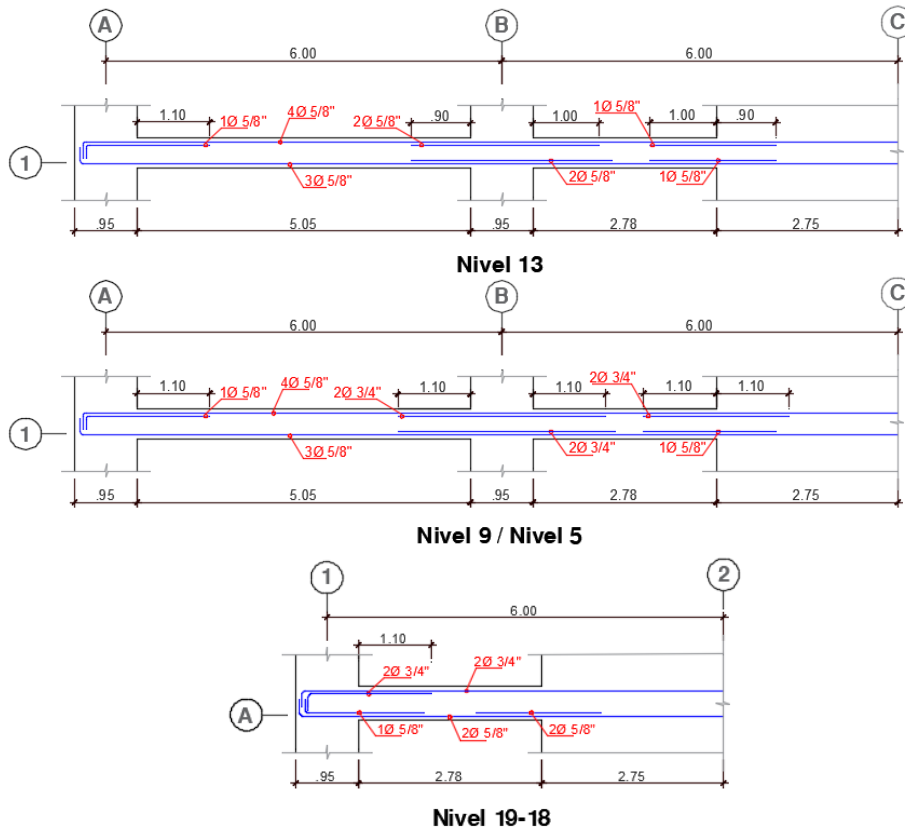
Refuerzo requerido por flexo-tracción en las vigas para el edificio Edi-20
